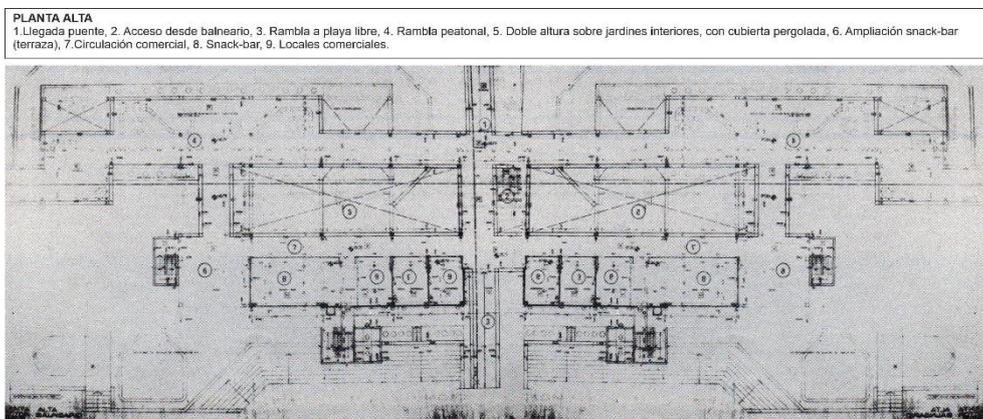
Planta alta de unidad balnearia, primer proyecto. Elaboración propia sobre plano en Proyecto Punta Mogotes (1980).
